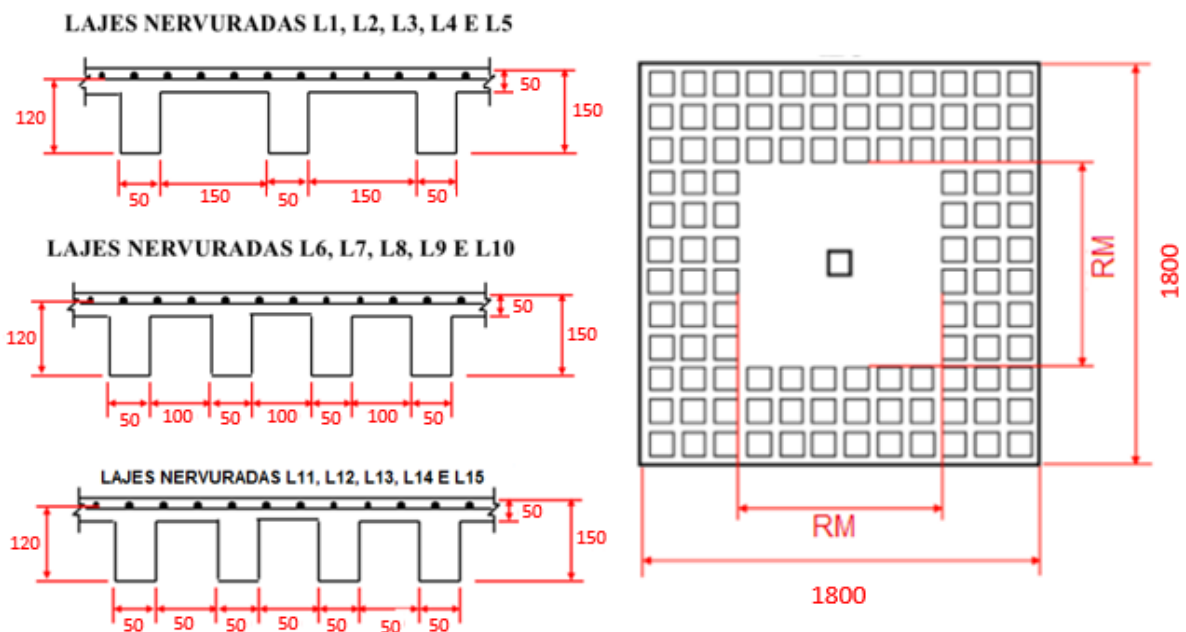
Detalhamento das lajes de Albuquerque (2009) com dimensões em mm.
